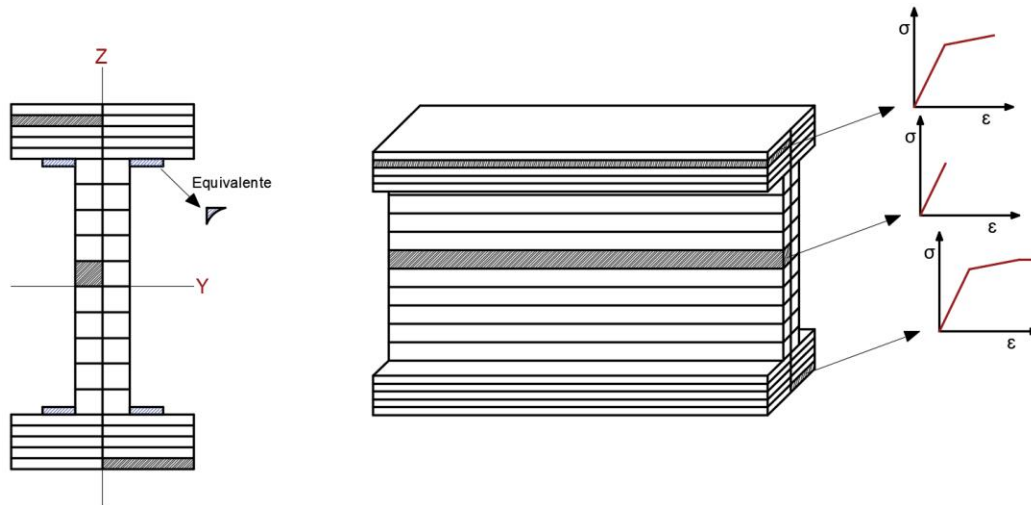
Ilustración de mallado de la sección transversal de elementos viga y columna
